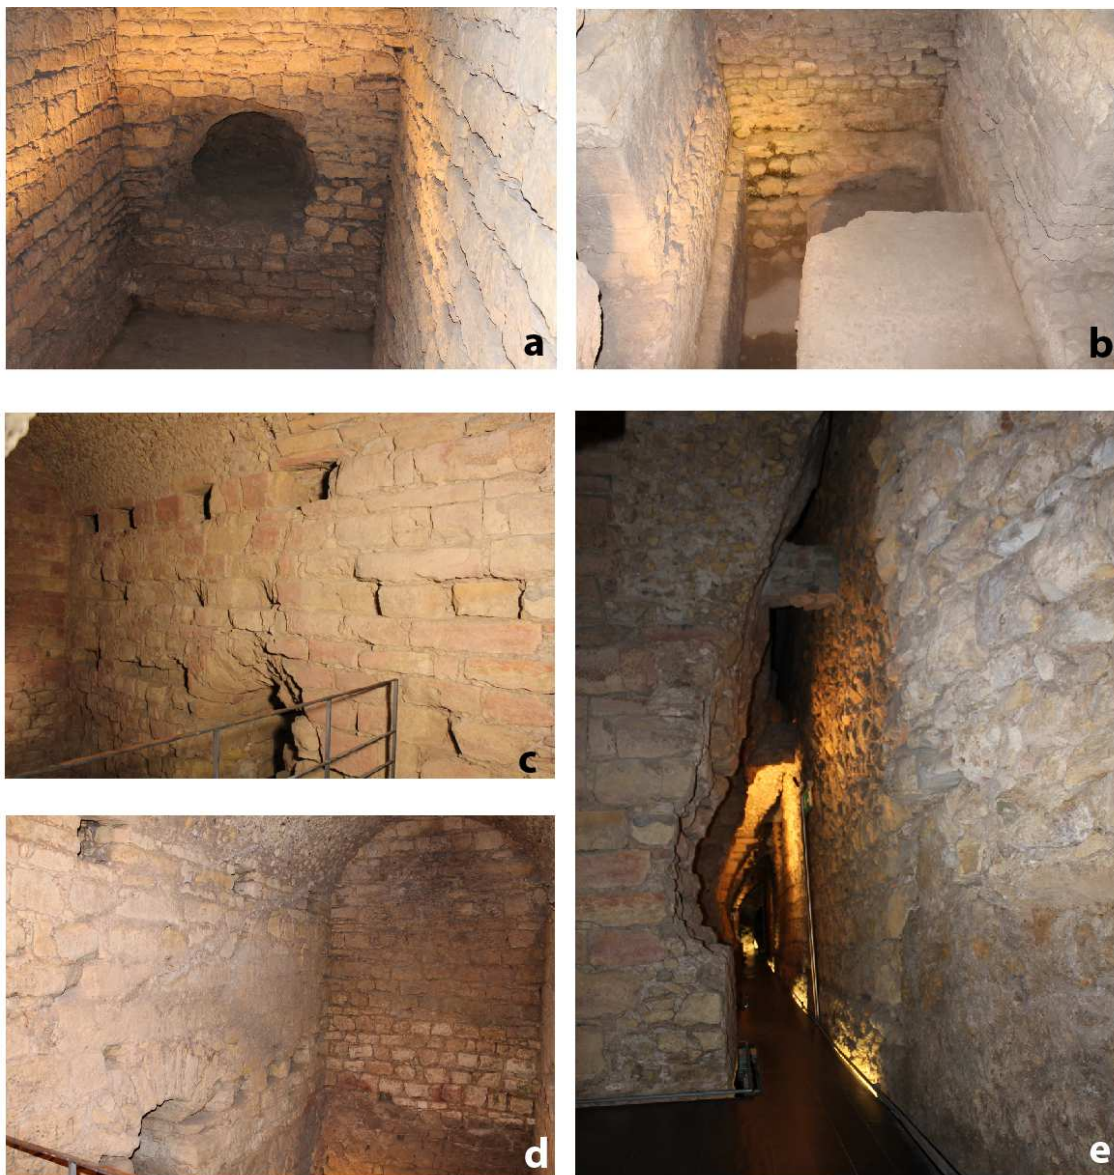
Piso inferior do criptopórtico. a: forno de carvão; B: embasamento da construção romana (C9); c-d: pormenor de entalhes de construções posteriores nas paredes laterais das *cellae*; e: Pormenor de corredor de acesso e parede anexa após projeto de musealização.
